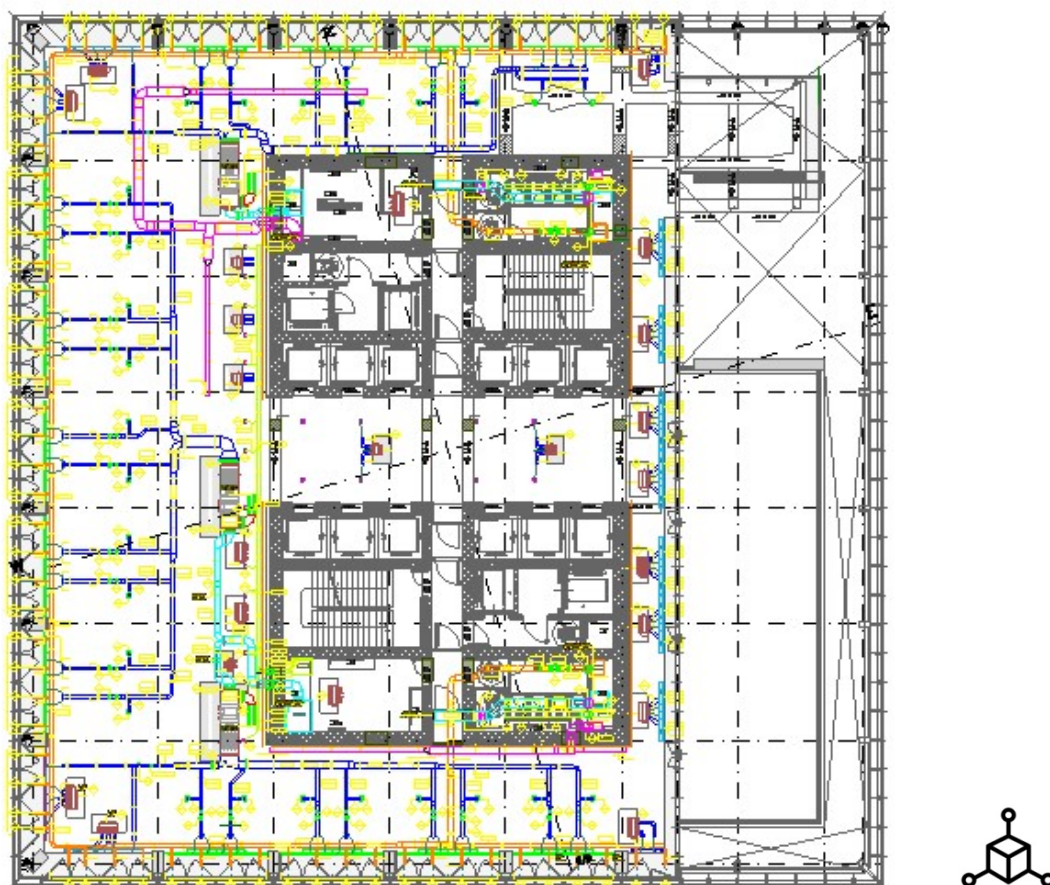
Pianta distribuzione impianti di ventilazione del piano trentesimo (fuori scala).
